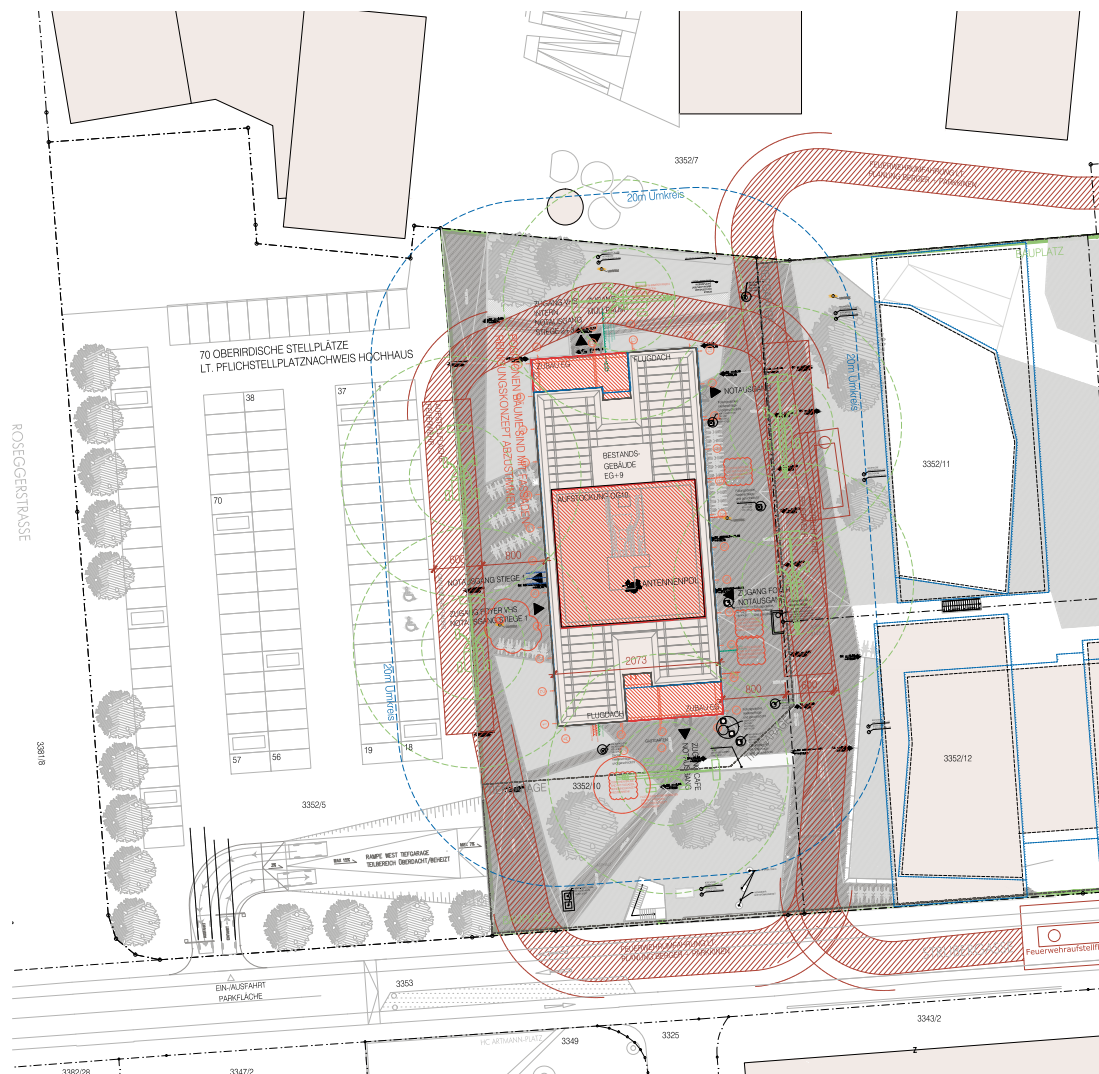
Stadtwerkhochhaus Lageplan, Riepl Riepl Architekten
